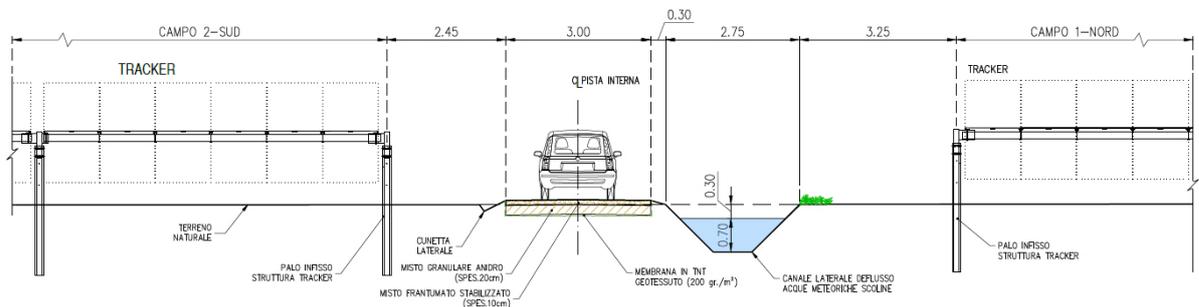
Sezione tipica della pista interna di gestione dell'impianto
